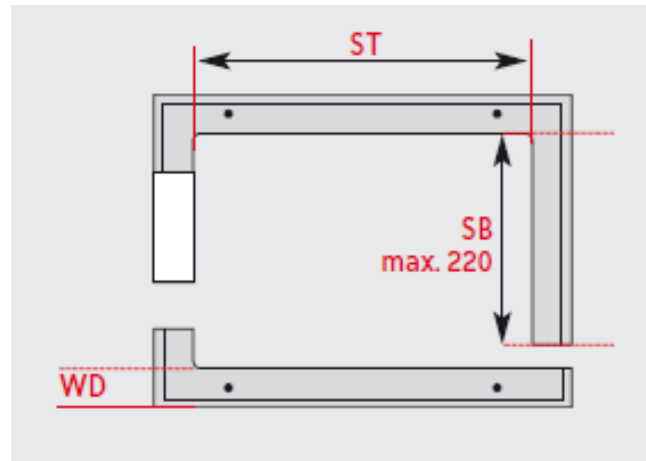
Konstruktionsprinzip 4 – Aufzugsschacht
